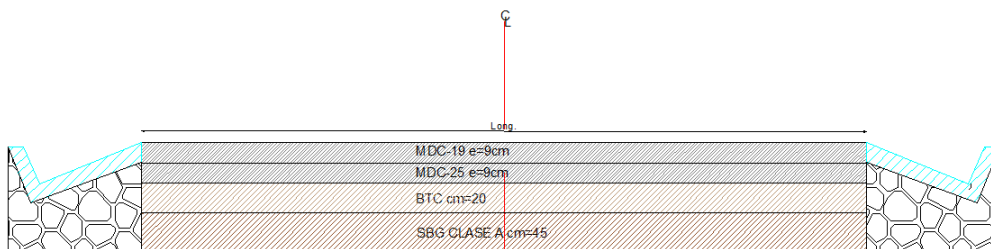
15. Sección Transversal Típica de Pavimentos - Pericongo
